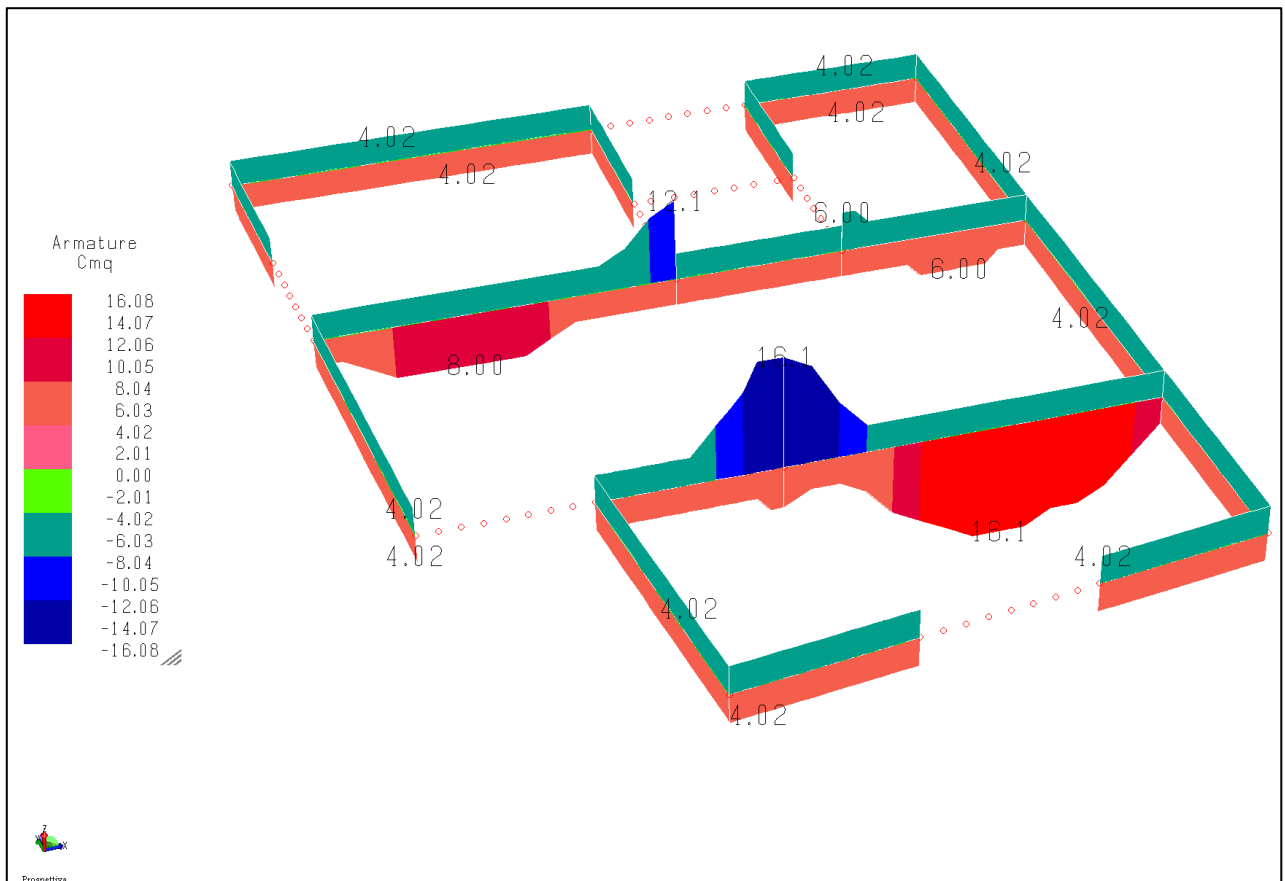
armatura longitudinale sulle travi del primo solaio (cmq)
